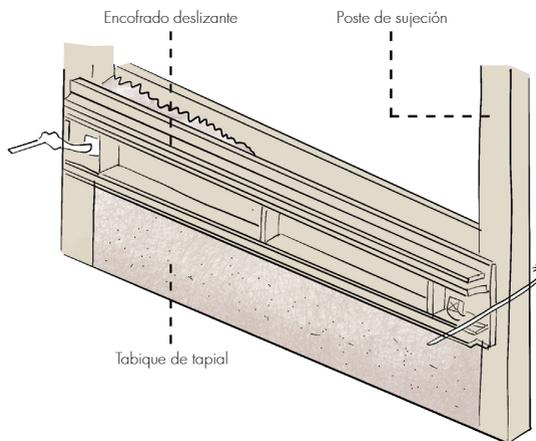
| Encofrado deslizable vertical. | Fuente: Autoría Propia (2024).
